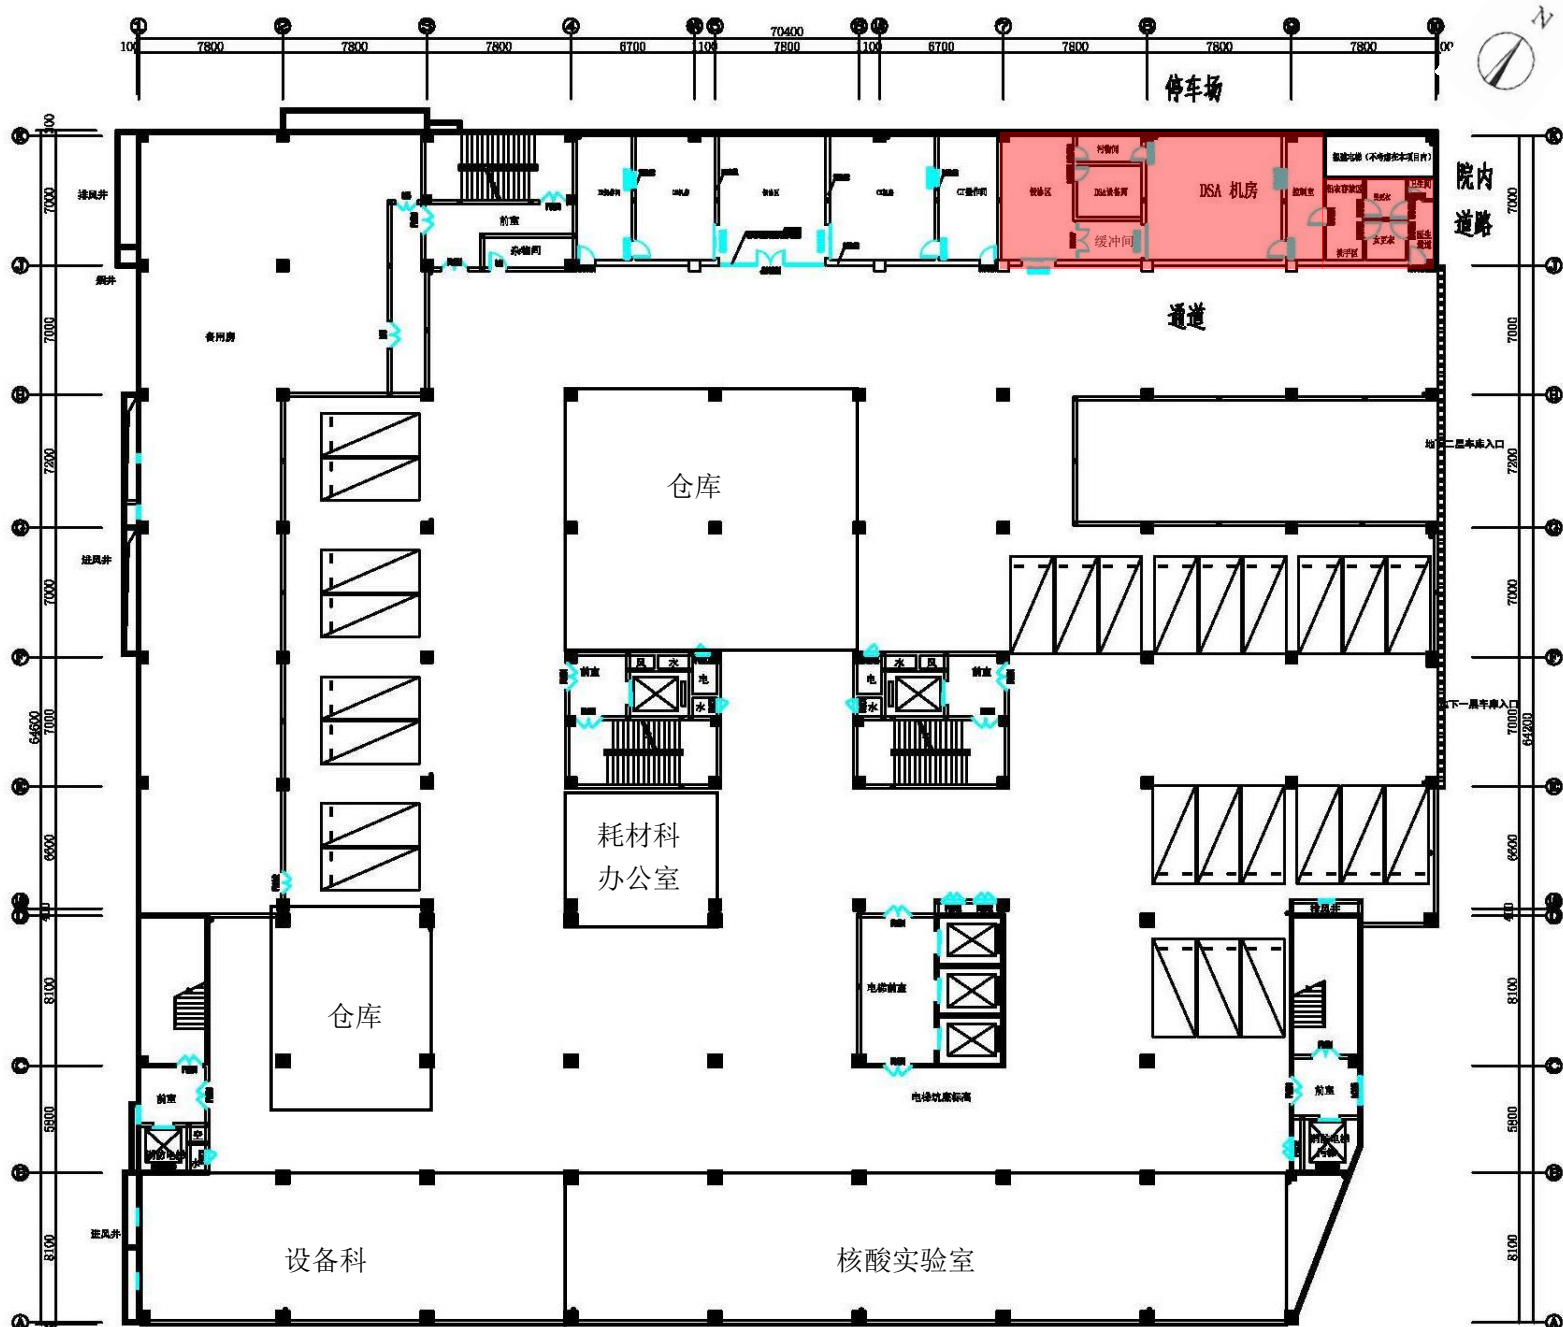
门诊综合楼负一层平面布置图 (本项目 DSA 机房及配套功能用房, 红框区域)
